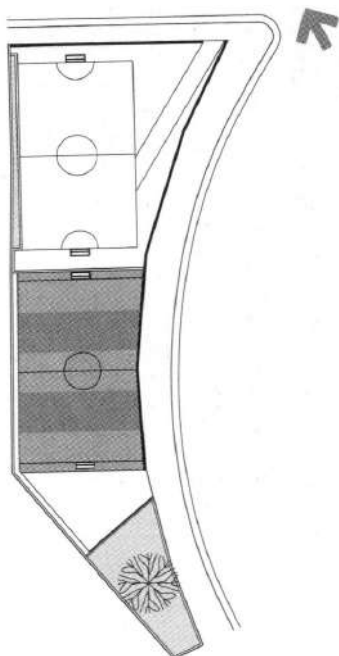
Planta arquitectónica de las Microcancha Pochote. Fuente : Barahona O., L. (2004).
